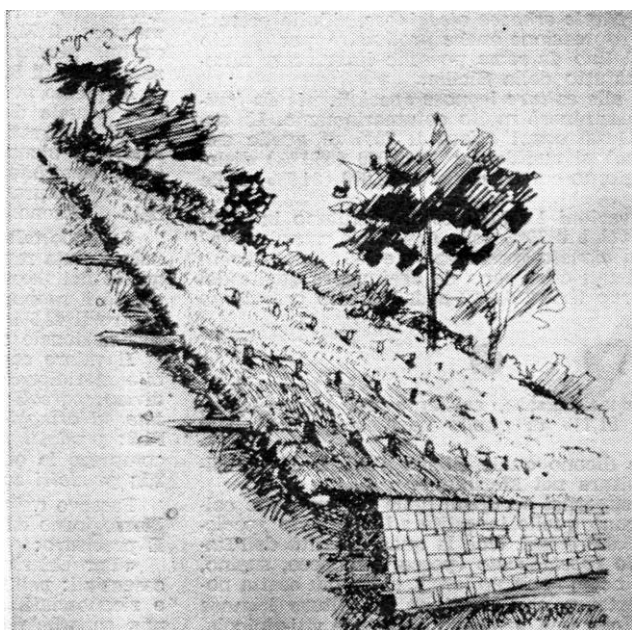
Assonometria di progetto di sistemazione di scarpata di strada di servizio mediante paletti infissi orizzontalmente e rivestimento vegetale (da Carullo, 1959)
